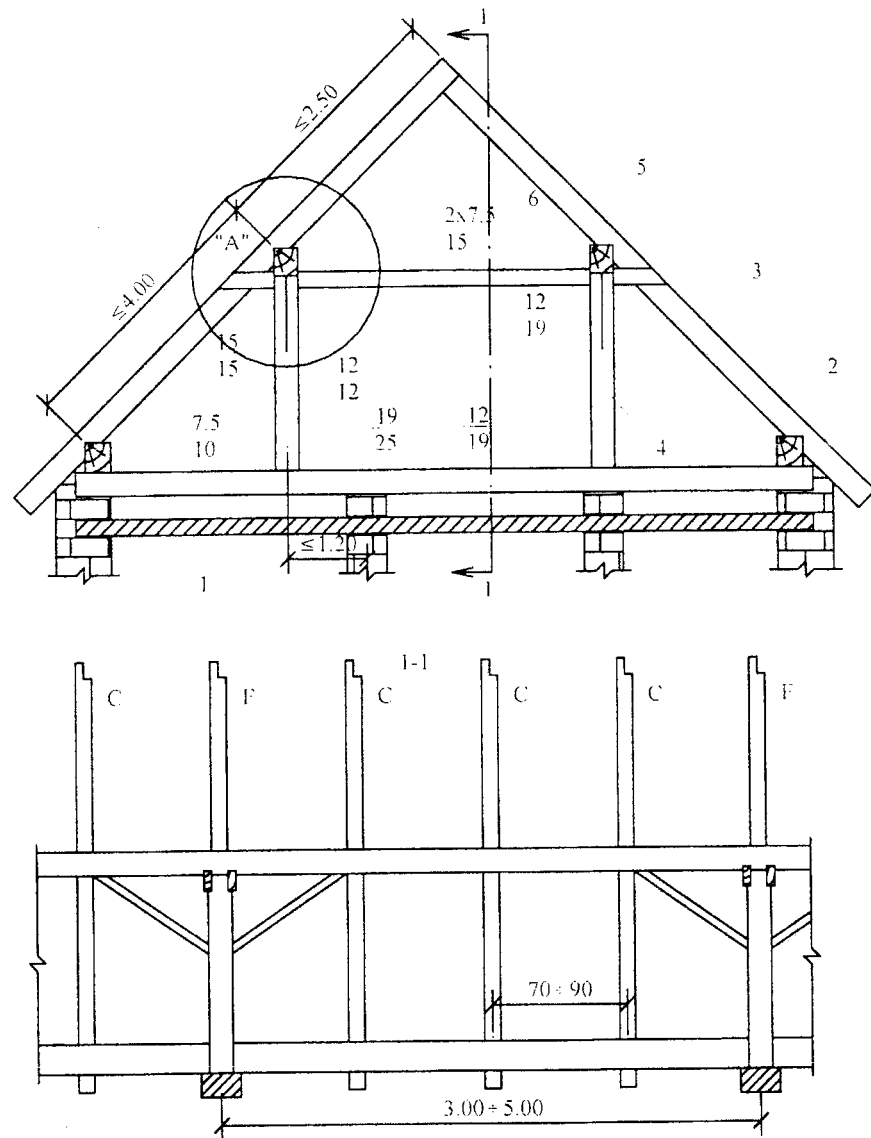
b - Șarpantă pe zid longitudinal median, pentru 9,00 m ≤ L ≤ 13,00 m.
